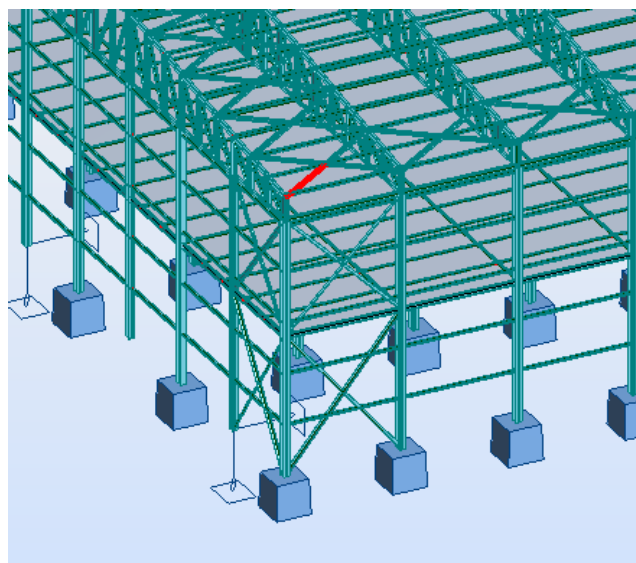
La diagonale du contreventement horizontal la plus sollicitée.
